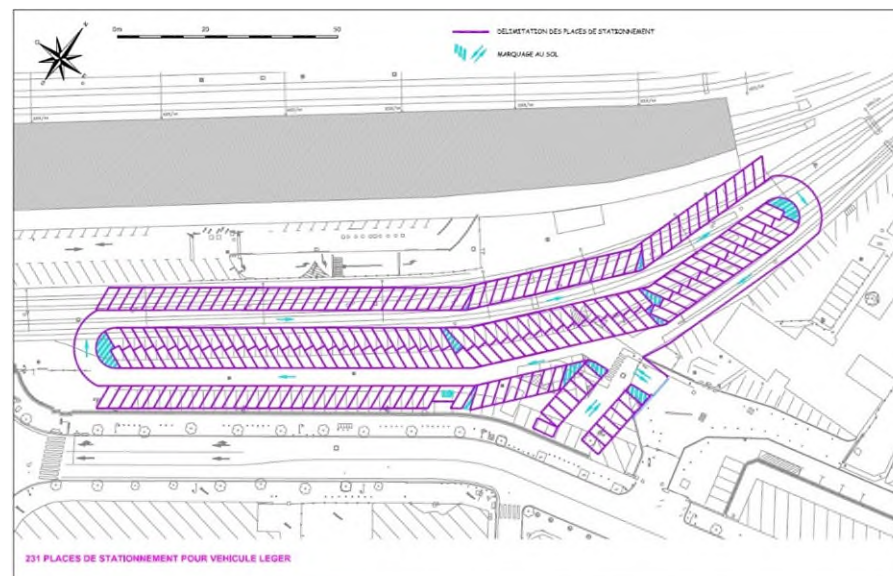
Plan de masse du projet parking provisoire Flammarion (source : Etudes APD - AREP, 2024)
